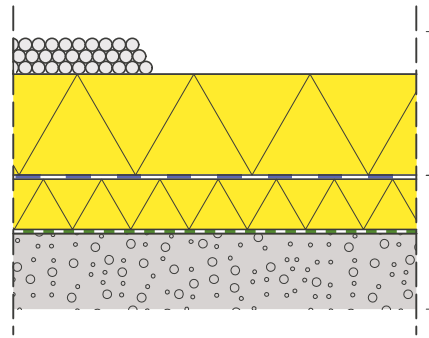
Toiture chaude + toiture inversée : toiture 'duo'.
